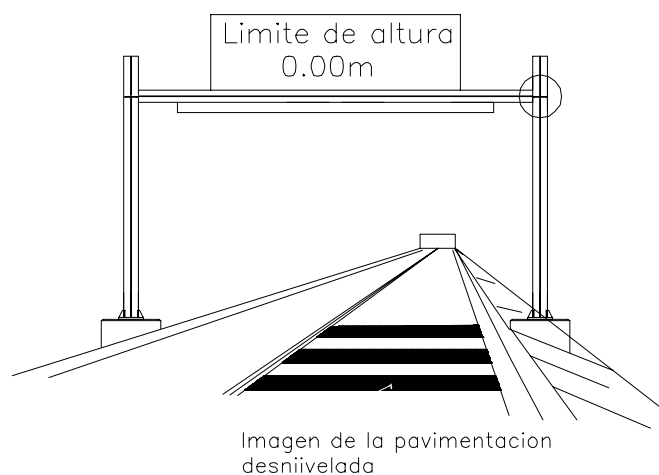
Imagen del Pórtico del límite de altura y la Pavimentación desnivelada
